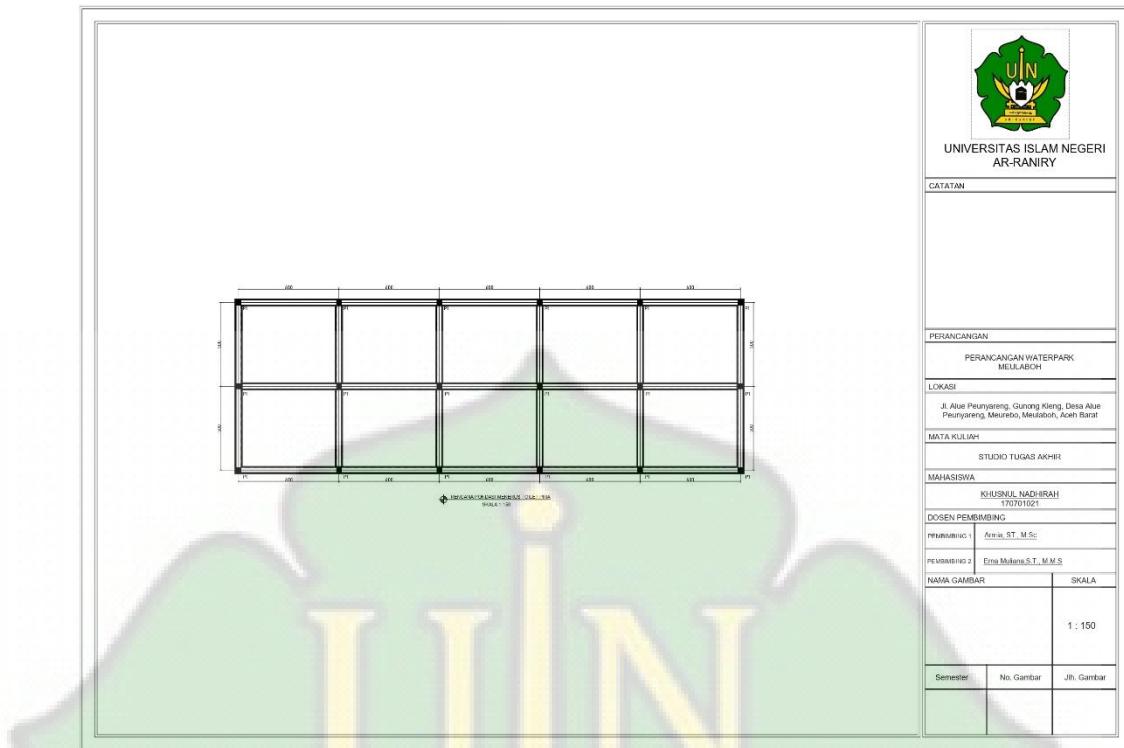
Detail Rencana Pondasi Menerus Bangunan Pengelola
